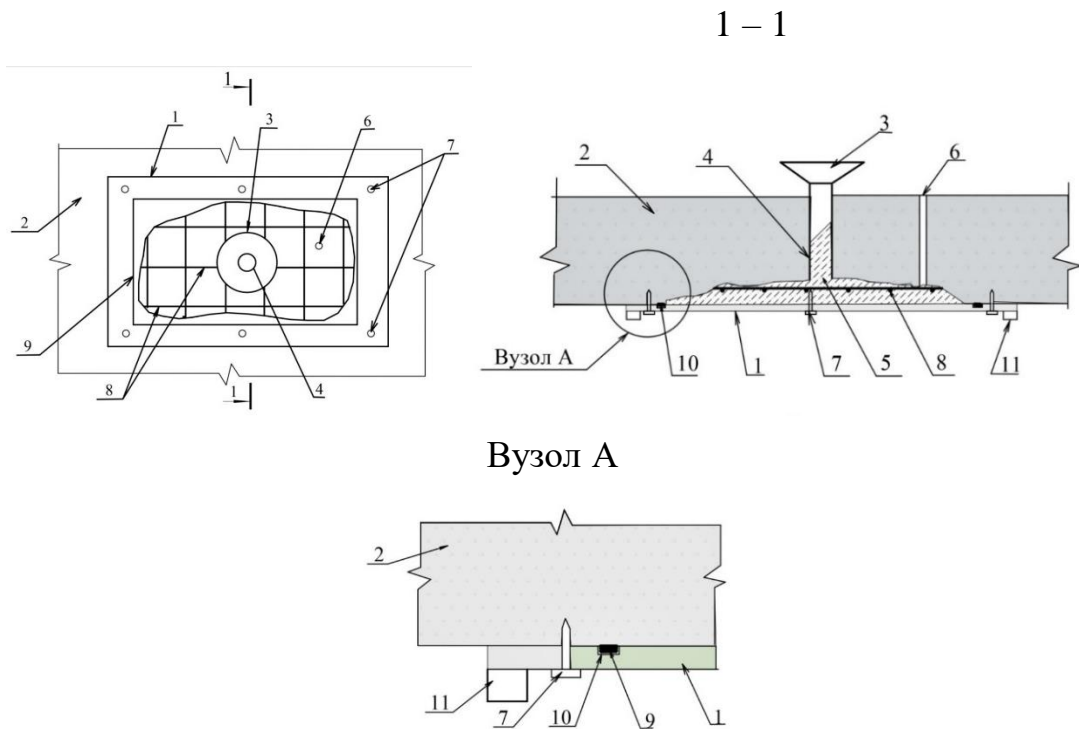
Вкладання ремонтної суміші в опалубку через наскрізний отвір в конструкції: 1 – опалубна конструкція; 2 – залізобетонна конструкція; 3 – лійка для подавання бетонної суміші; 4 – отвір в конструкції $\varnothing 60$ мм для подачі бетонної суміші; 5 – ремонтна суміш; 6 – отвір $\varnothing 8$ мм для виходу повітря та контролю наповнення опалубки ремонтним розчином; 7 – анкерні кріплення; 8 – арматурні стрижні; 9 – гумовий ущільнювач; 10 – паз в опалубному щиті; 11 – ребра жорсткості опалубки
